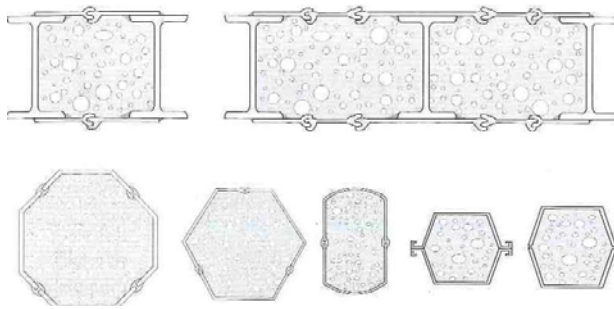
Secciones por cajón obtenidas por soldadura longitudinal de tablestacas y empleadas como pilotes metálicos
